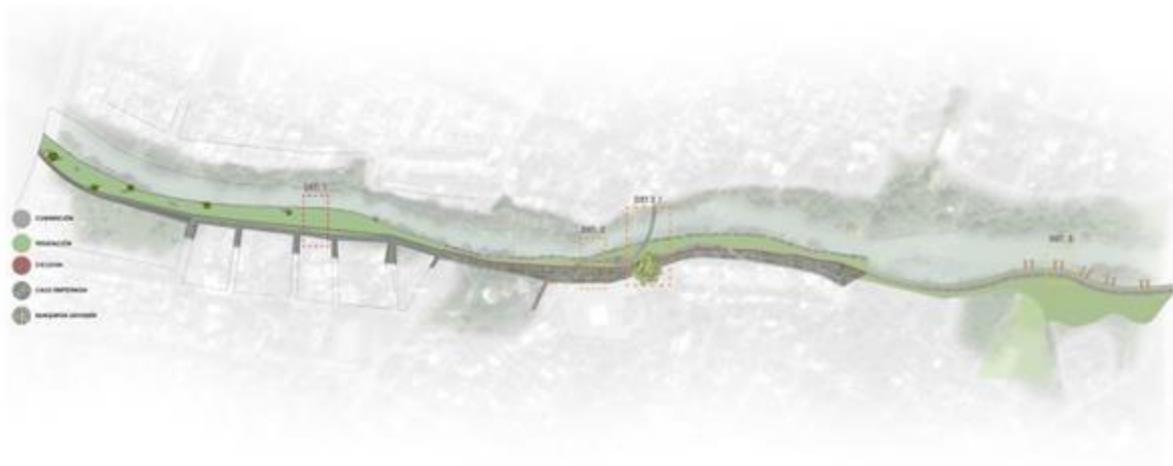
Propuesta planta de conjunto - Tramo 1
